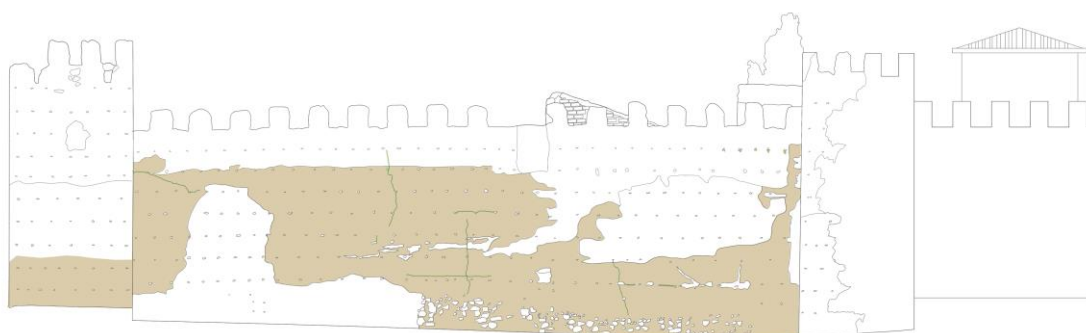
Detalle de fisuras, grietas y oquedades en el lado lateral torre C. Fuente: Autora.
